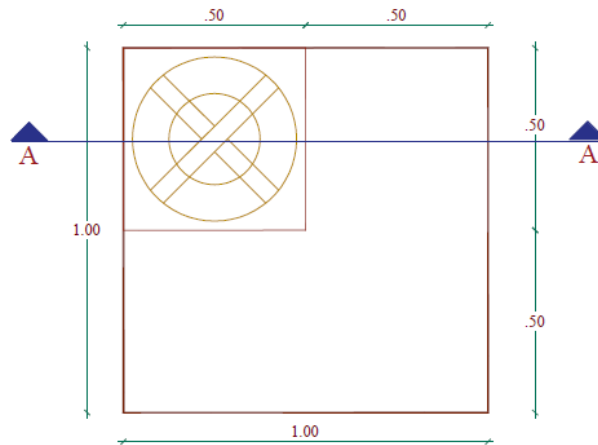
Planta de la gaveta, pozo de ensayo e infiltrómetro
